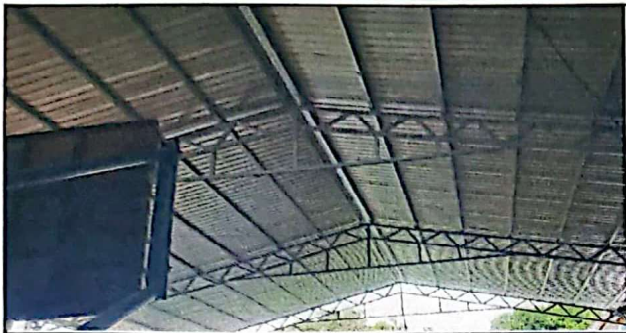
Instalación de capotes metálicos en techo, 16 ml
